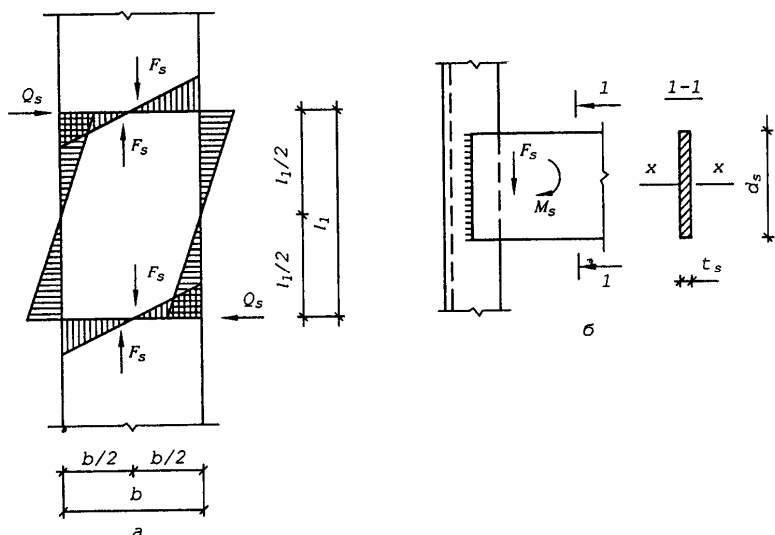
Розрахункові схеми наскрізної колони на планках:
